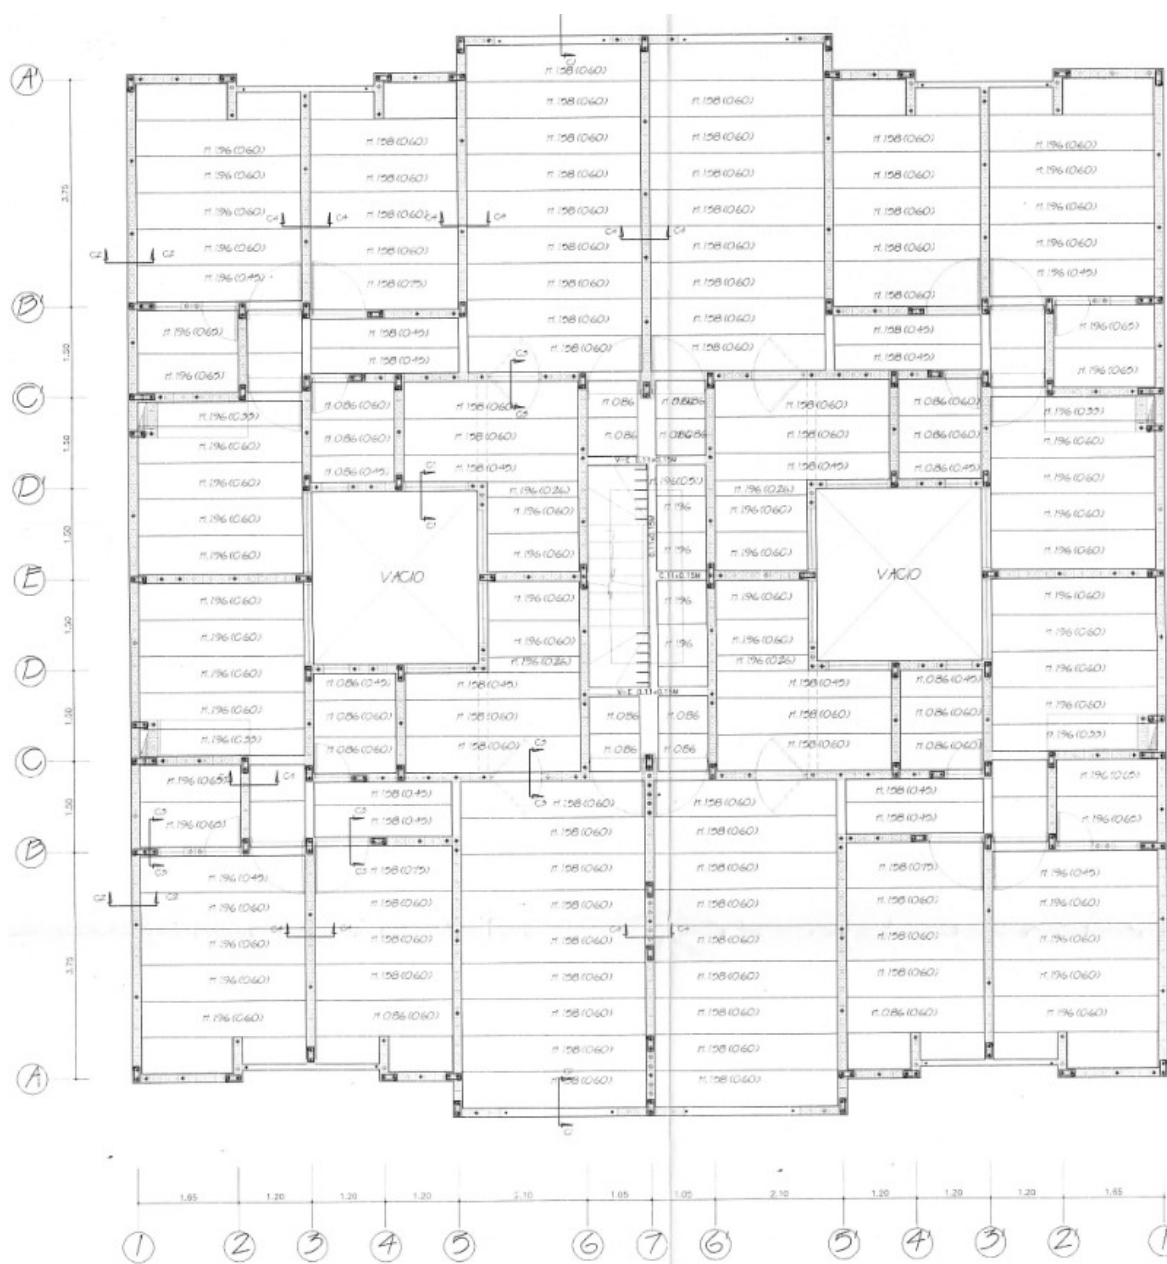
Losa de entpiso. (Fuente. Plano estructural 01).
